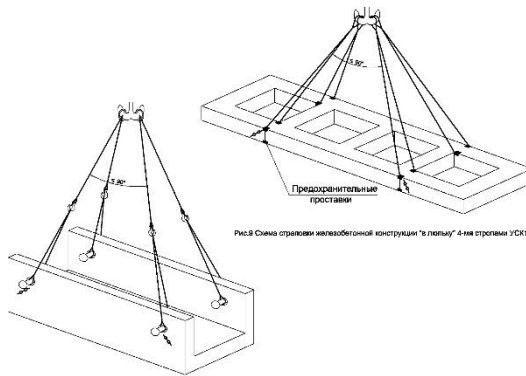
Схема стропки железобетонной конструкции "в лопуши" для стропы УСК1
